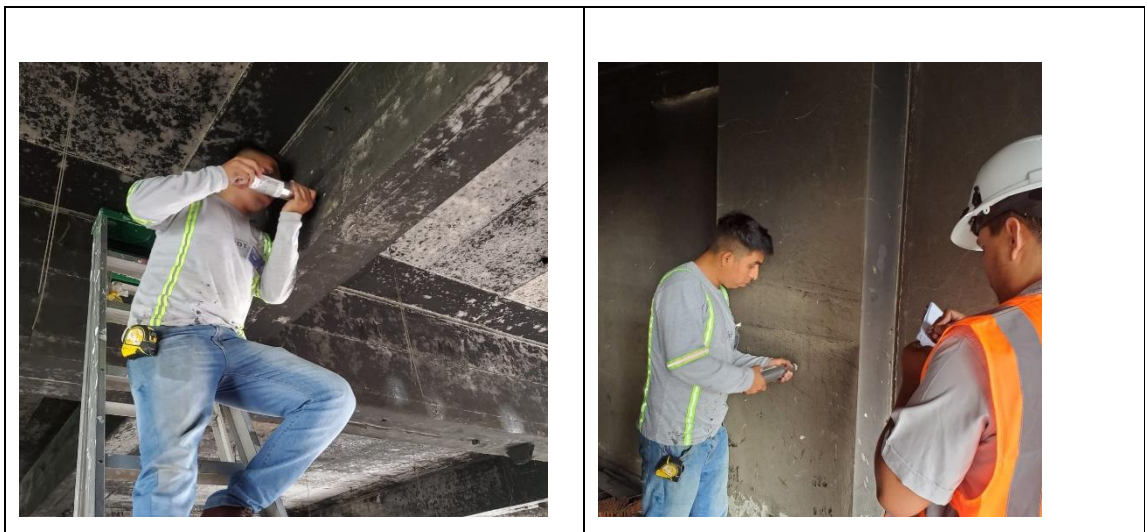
Detallado de refuerzo – Columna C-1 (3/D).
